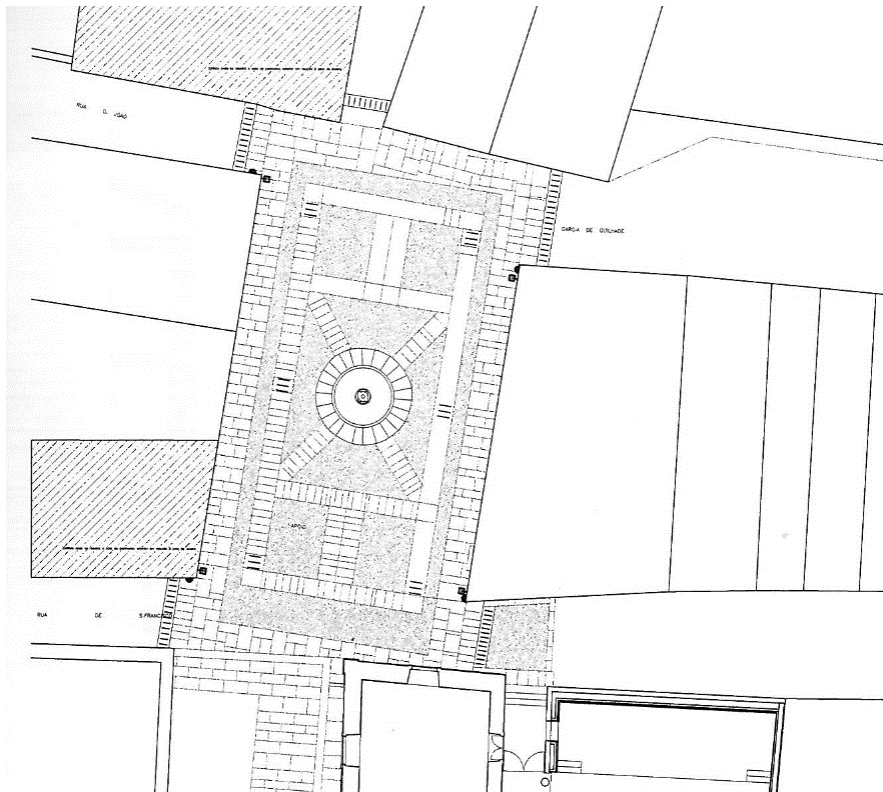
Projeto de Execução do Largo do Apoio – Planta S/E
